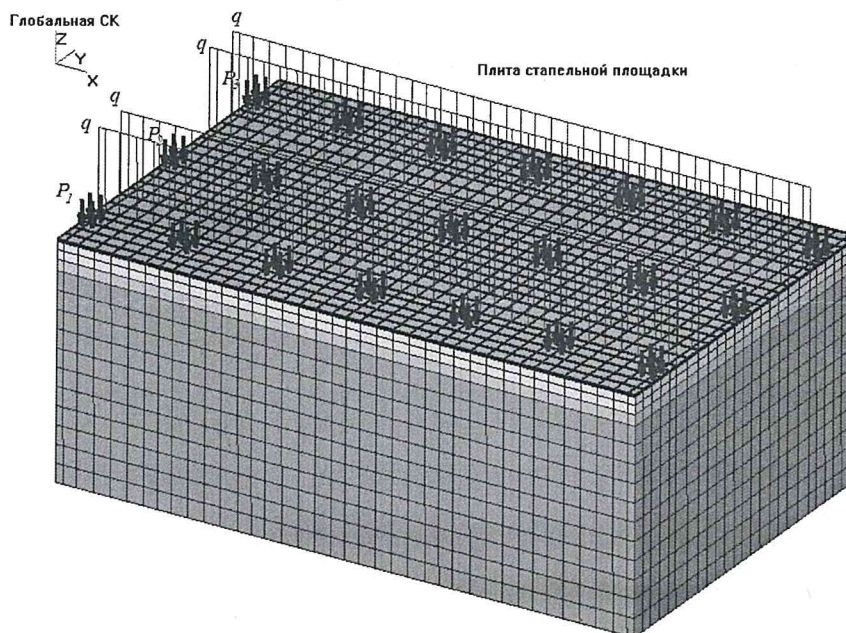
Конечно-элементная схема стапельной площадки док-камеры
